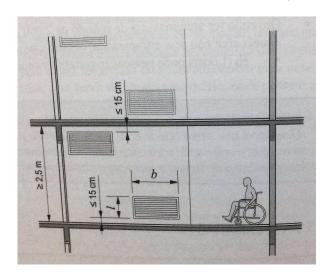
ABERTURAS DE ENTRADA DE AR E EXTRAÇÃO DE FUMAÇA
